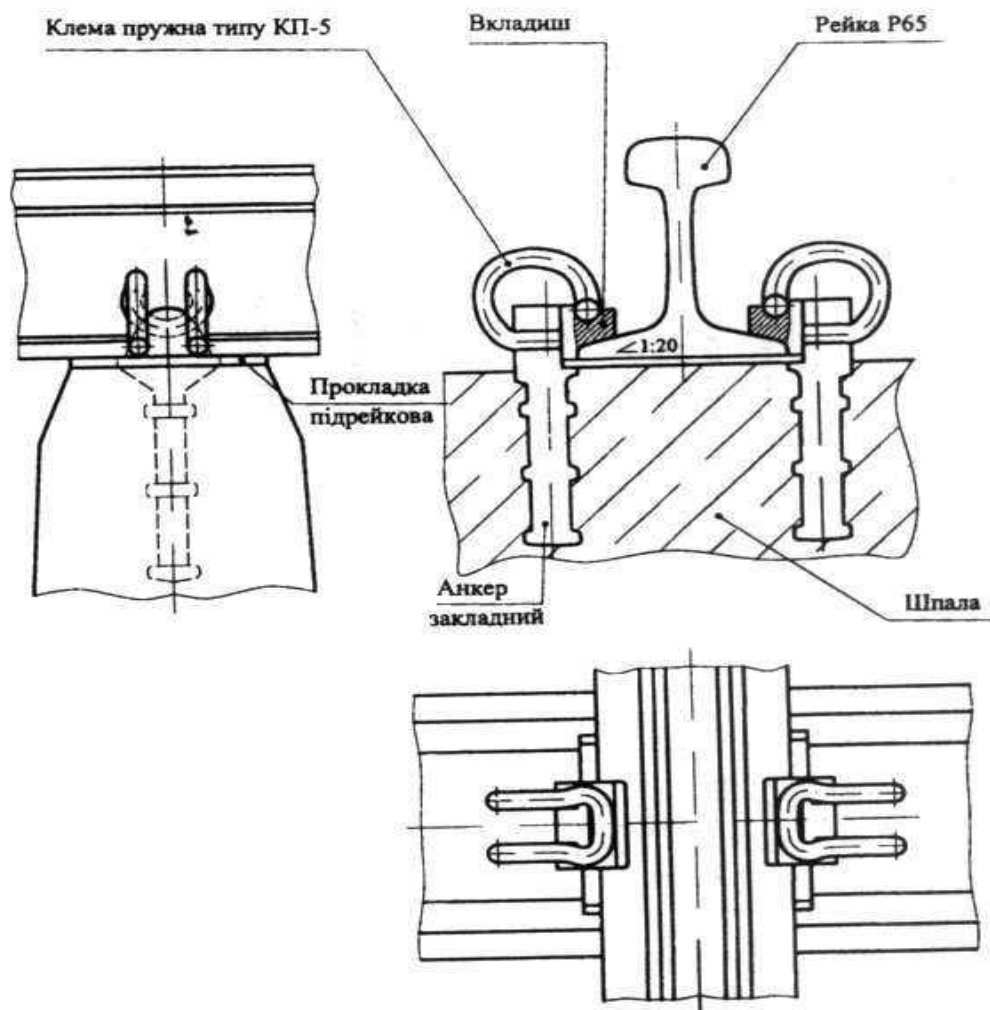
Безпідкладочне проміжне пружне скріплення типу КПП-5 з клемами типу КП-5.2
